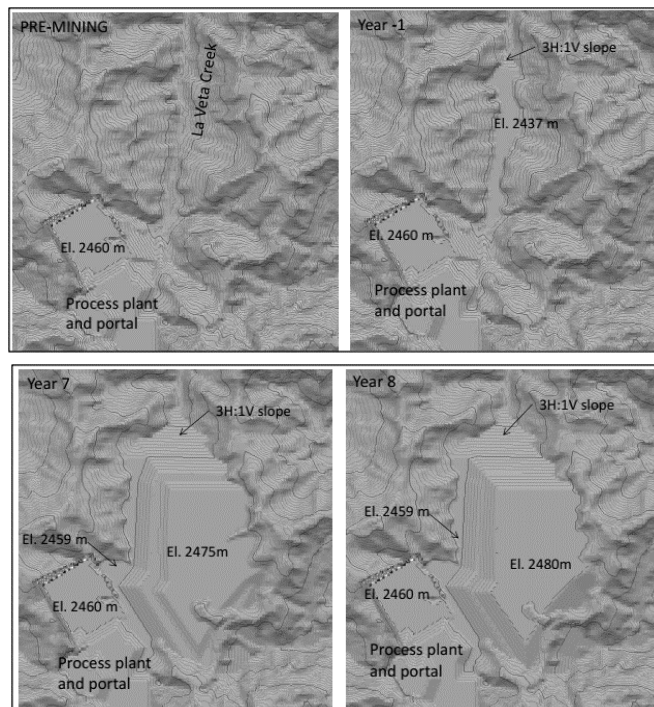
Proyecto minero Santa Rosa. Configuración proyectada del "Dry Waste Management Facility" (DWMF)
